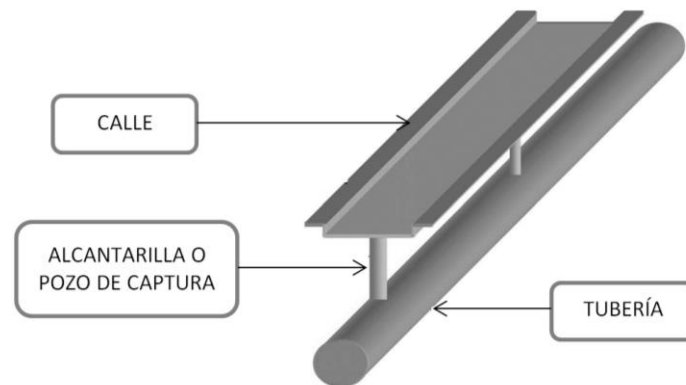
Conexión entre las tuberías y el sistema de calles.
